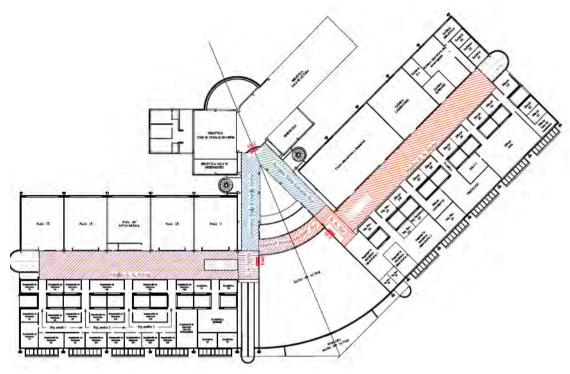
Vista en planta de los espacios docentes en la sede campus de la EEI (Edificio I – Planta Baja)
